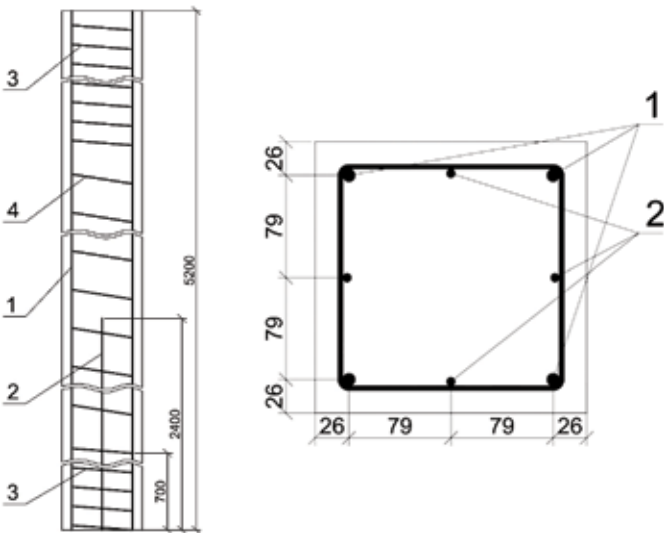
Схема армирования стойки СОН: а) вид спереди; б) поперечное сечение; 1 – напрягаемая арматура класса А800 Ø14; 2 – ненапрягаемая арматура класса А800 Ø14; 3 – поперечная спираль в опорных частях с шагом 50 мм класса А240 Ø4; 4 – поперечная спираль в центральной части с шагом 100 мм класса А240 Ø4
